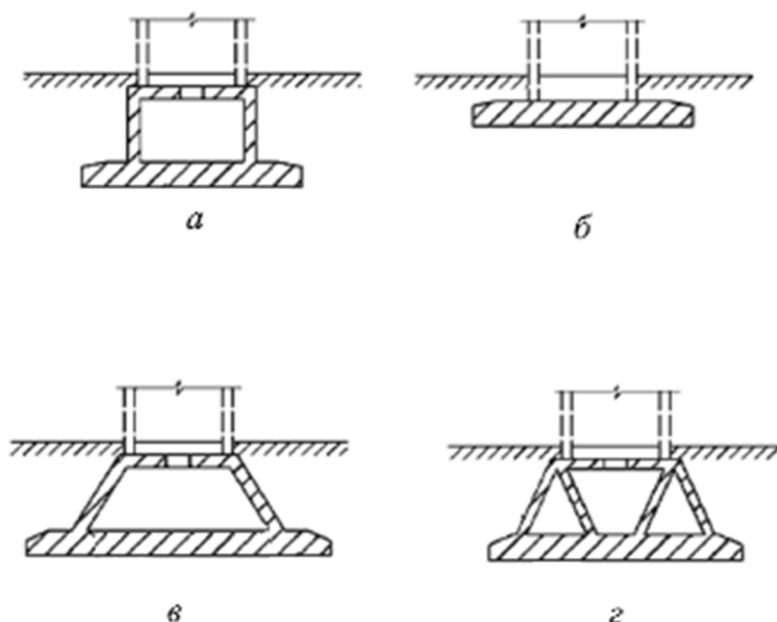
Виды фундаментов водонапорных башен по конструкции
